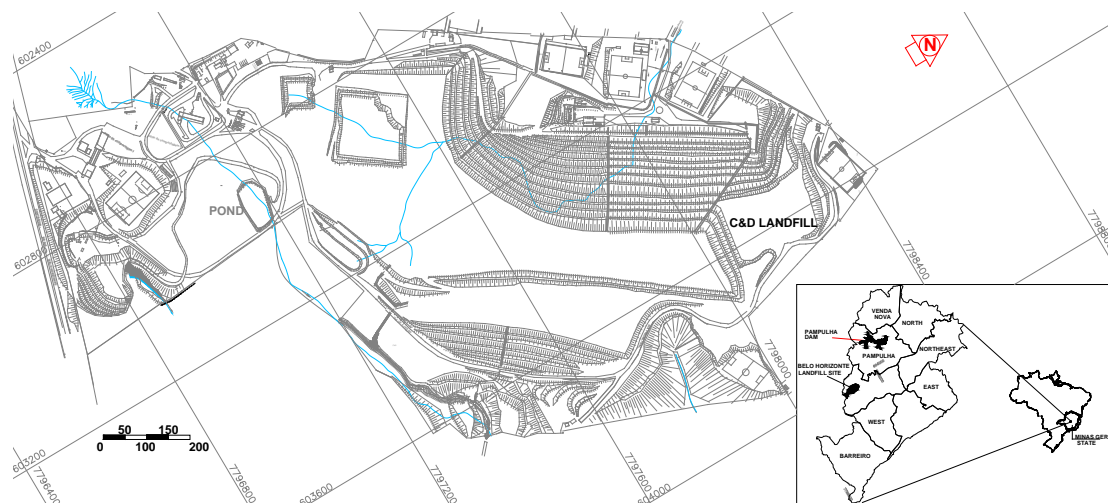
Aterro Sanitário de Belo Horizonte – Lay-out
